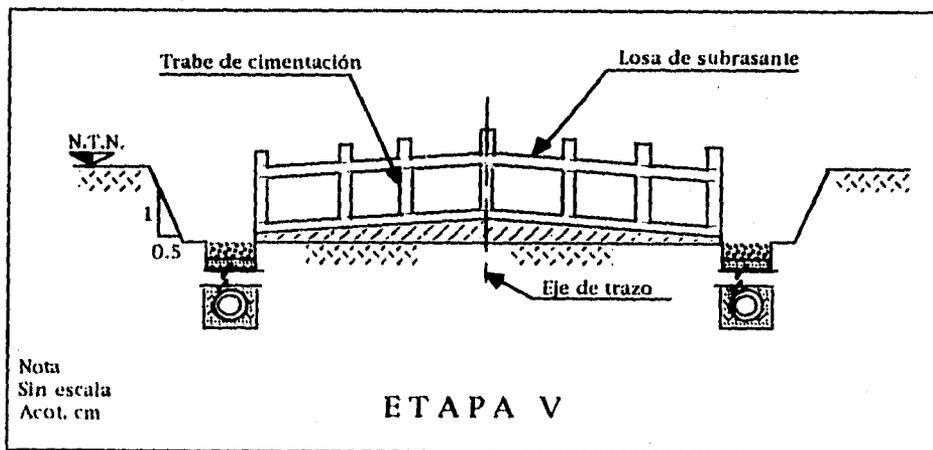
ETAPA V Armado y colado de la sección estructural incluyendo losa de sub-rasante.
